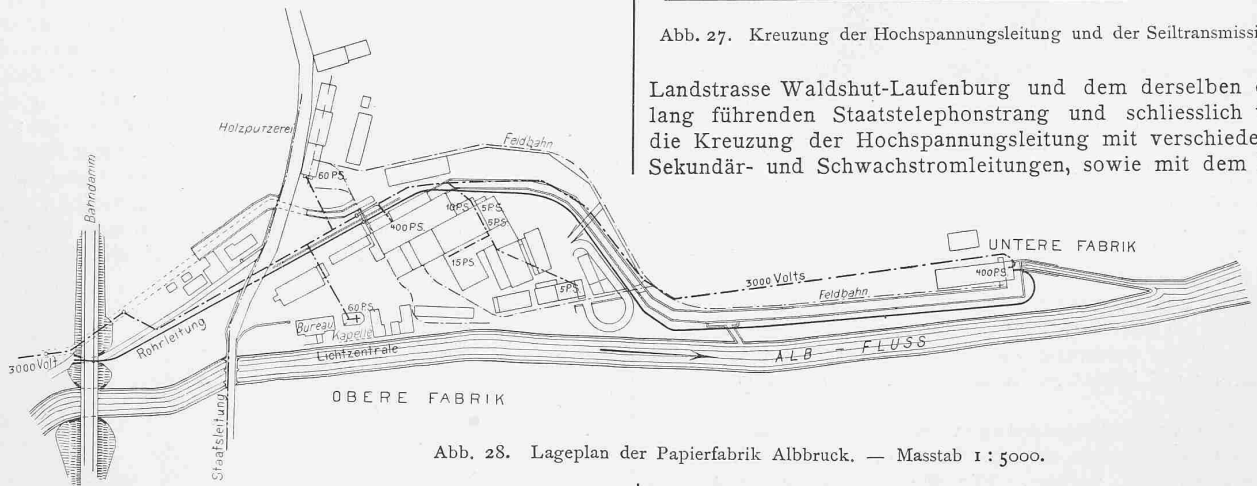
Lageplan der Papierfabrik Albruck. — Masstab 1:5000.
